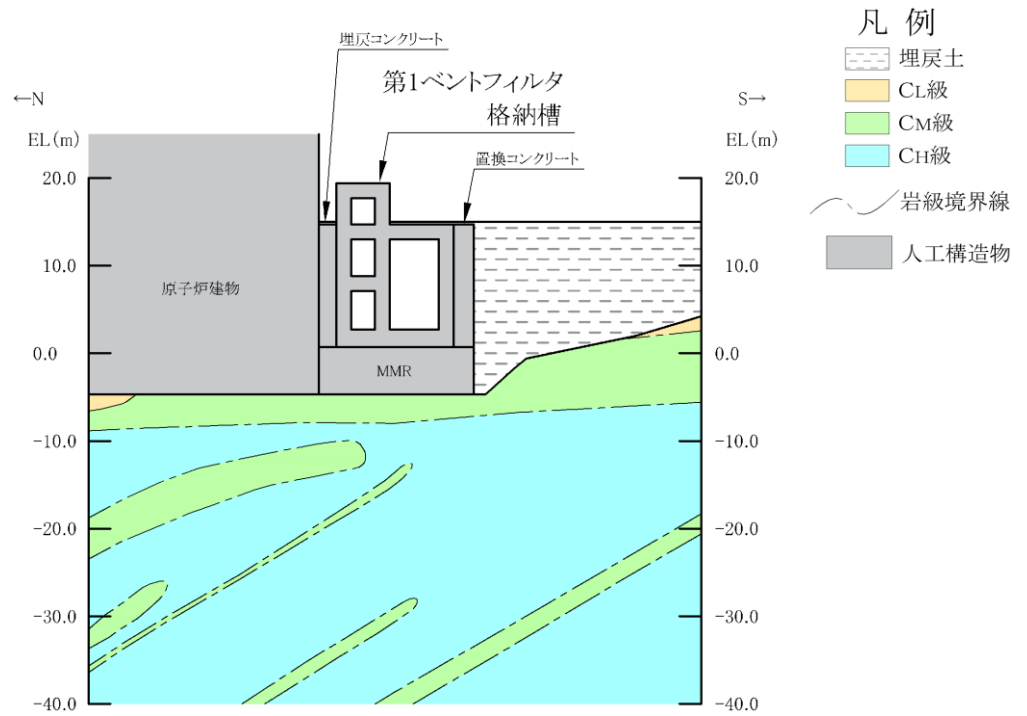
第 1 ベントフィルタ格納槽 評価対象断面図 (A-A断面位置)
